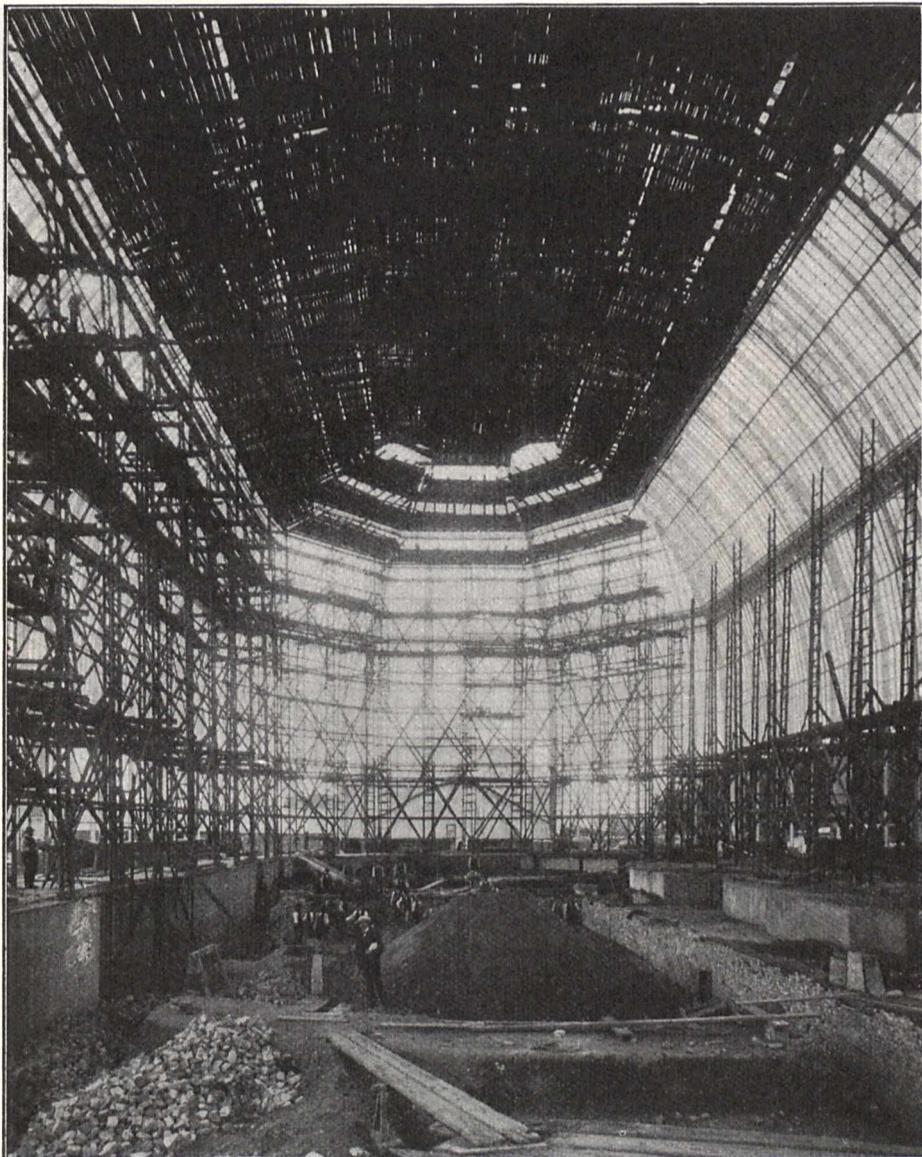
Großes Tropenhaus. Gerüst für den Ausbau.
